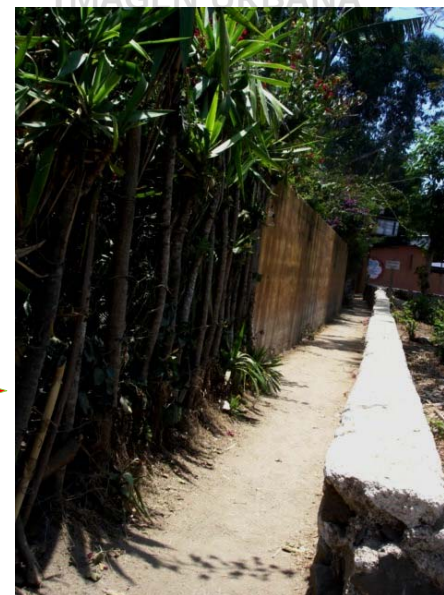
El caminamiento no está adoquinado, no existe área con vegetación, los muros de las fachadas se encuentran sucios, con moho, falta de cerco para delimitar propiedad.
